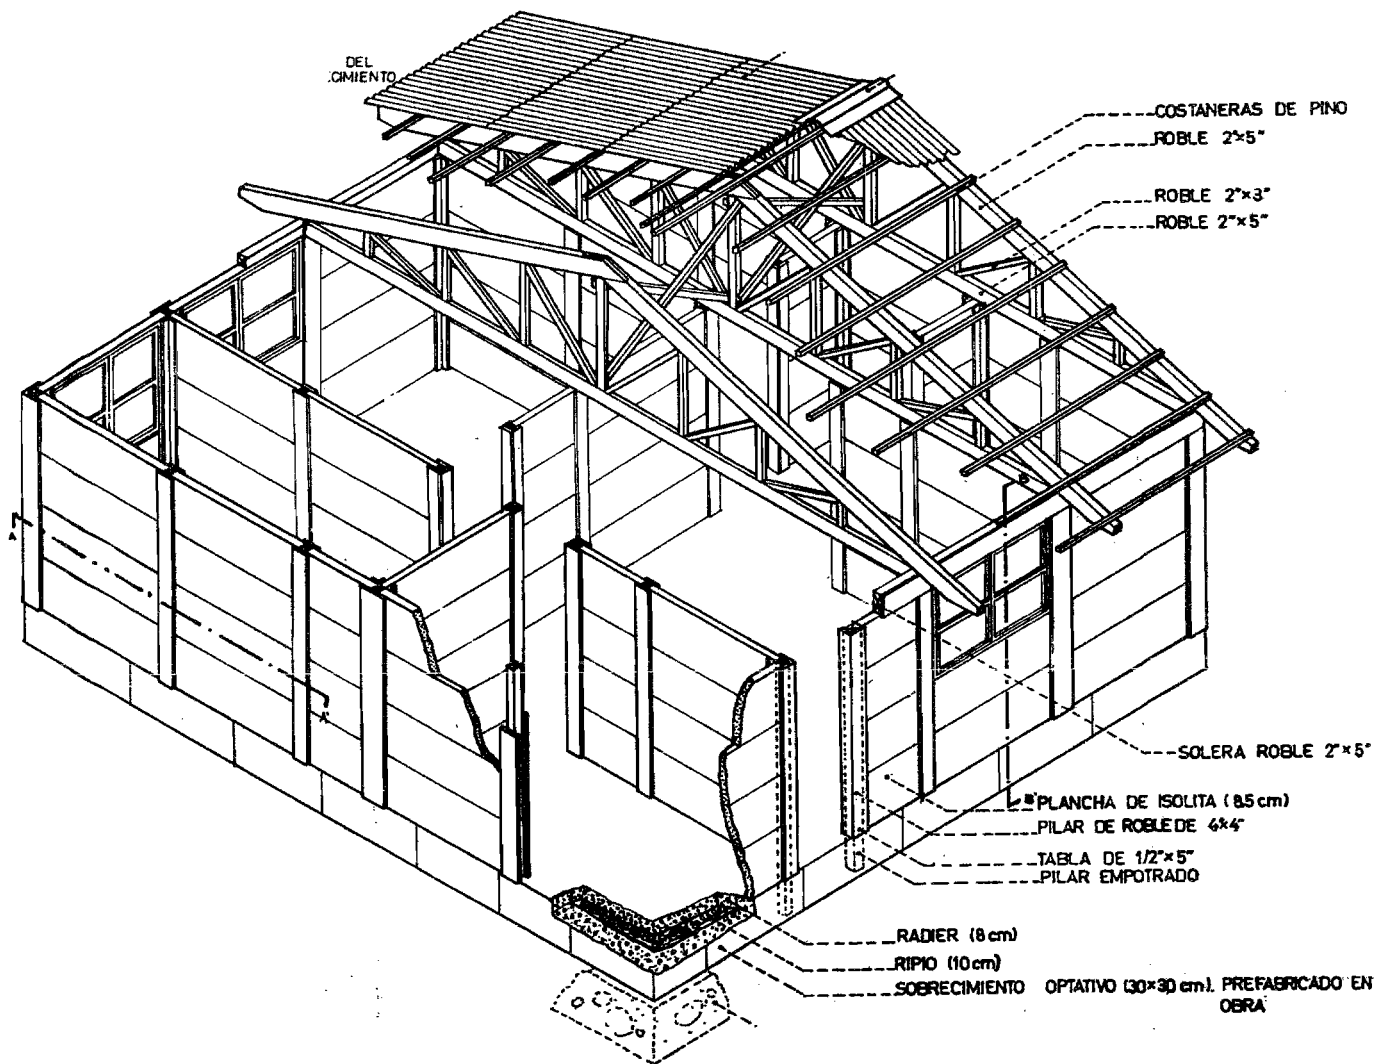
Casa ISOLITA. Sistema de prefabricación parcial cuyos muros están formados por una estructura de pies derechos de madera y planchas de ISOLITA entre ellas.
